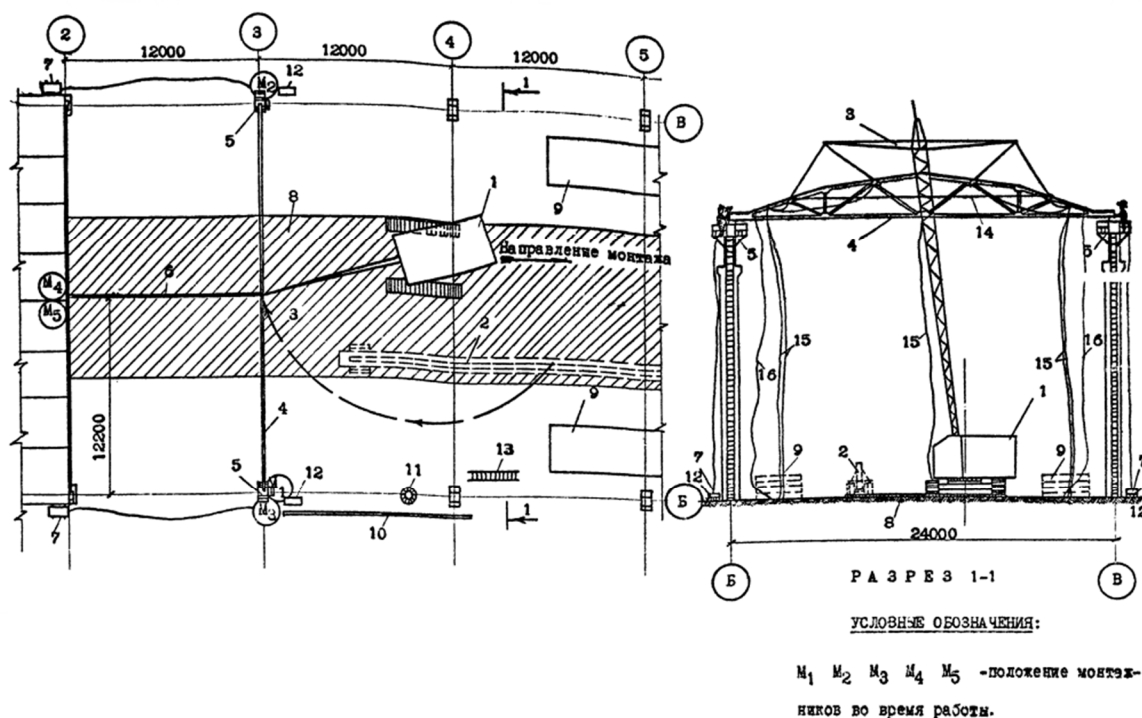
Схема организации рабочего места при монтаже стропильных ферм:
